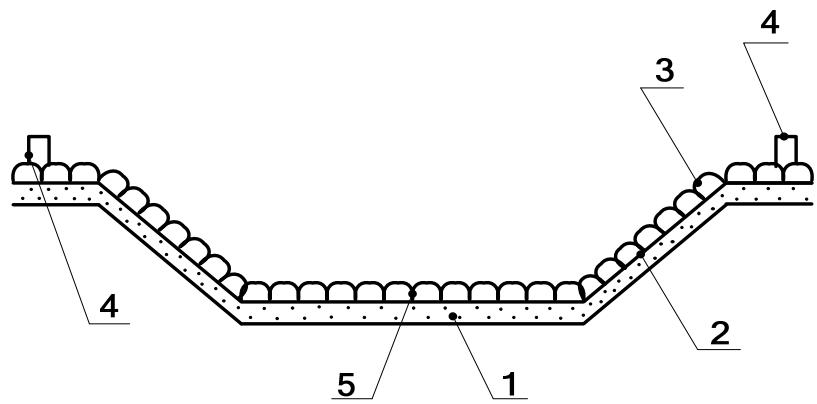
Противофильтрационное геотекстильное покрытие водопроводящих каналов
